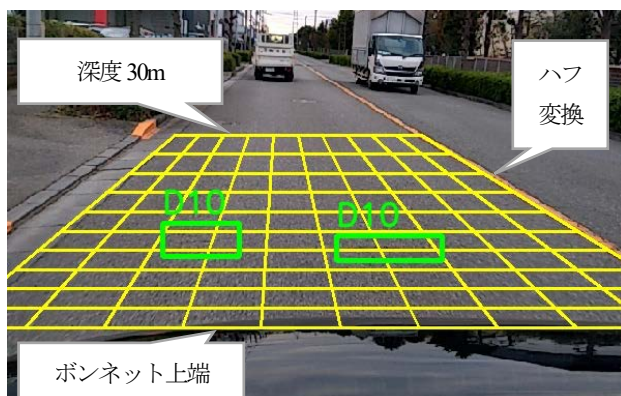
舗装ひび割れ率計算用台形領域生成例
